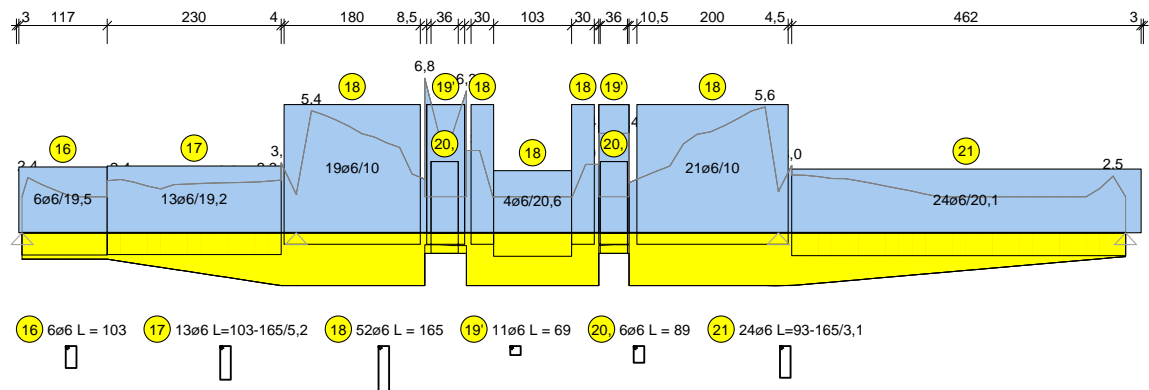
Konstruierte Querbewehrung. Maßstab 1 : 100, 1cm = 3,33cm<sup>2</sup>/m und 66,67cm Bügelabstand.
